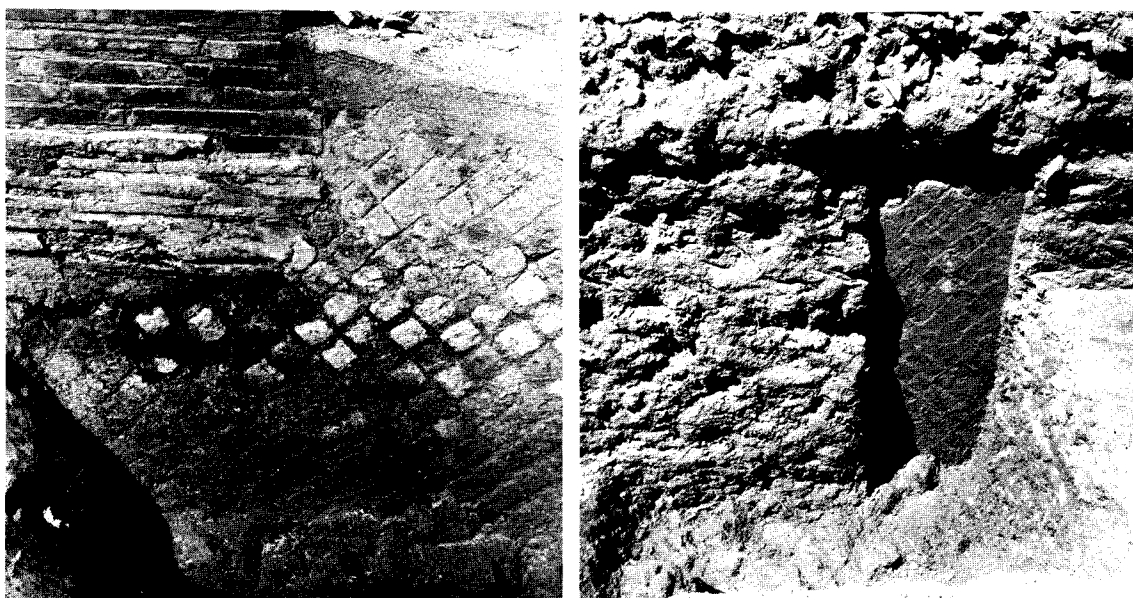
Saggio *d*: l'innesto del muro A² sul muro A; in basso la sommità del muro B.
